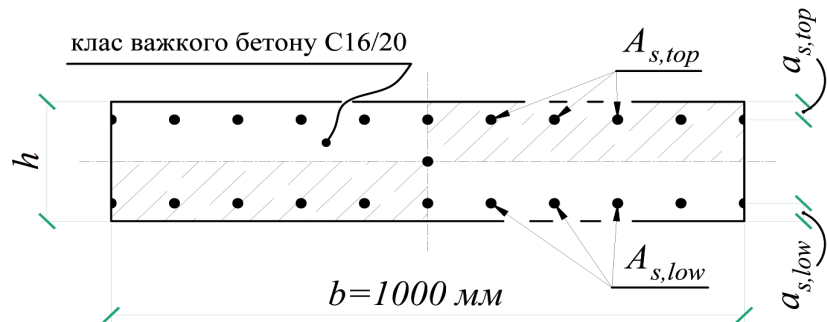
Геометричні розміри та схема армування нормального перерізу залізобетонної плити
